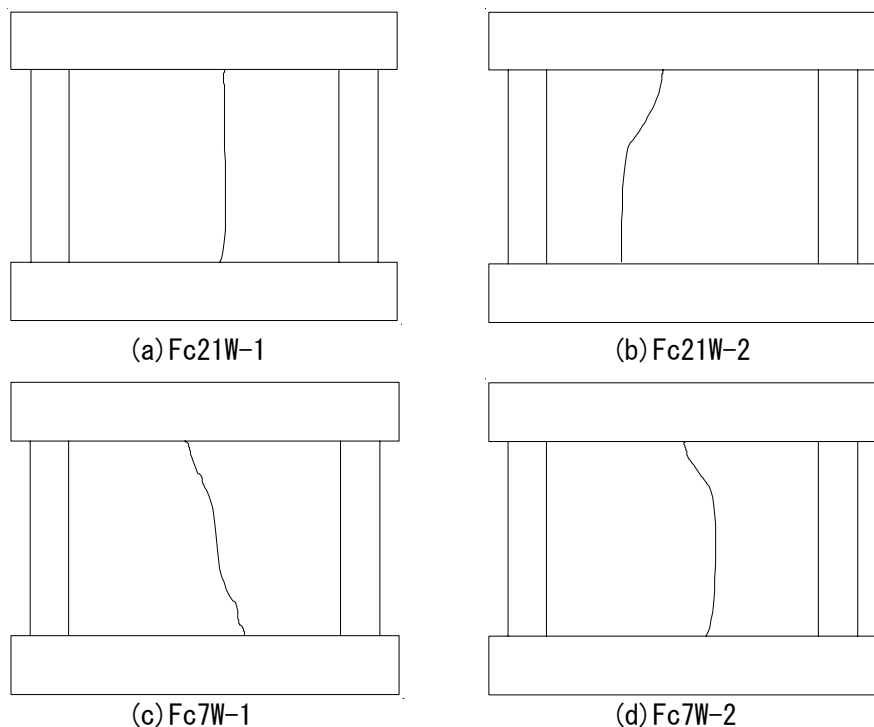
乾燥収縮ひび割れ発生状況図
